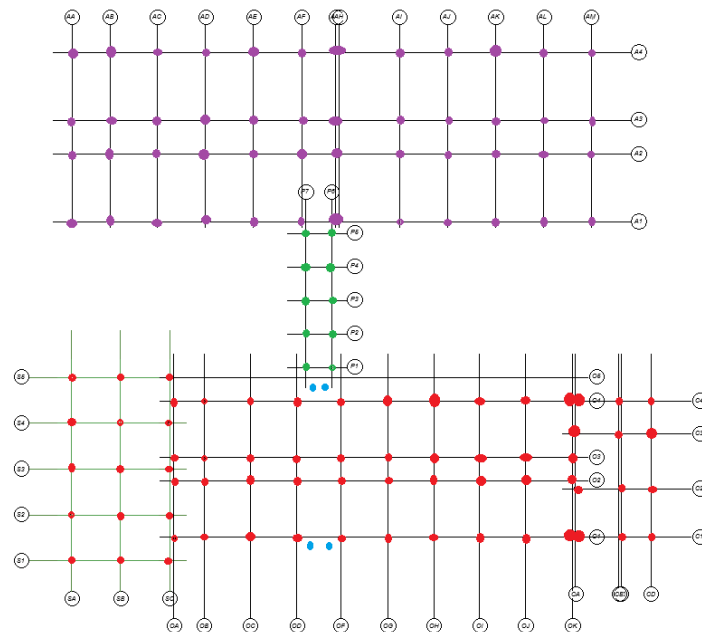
Vista en planta con los diferentes tipos de pilares distinguidos por colores según tipología
